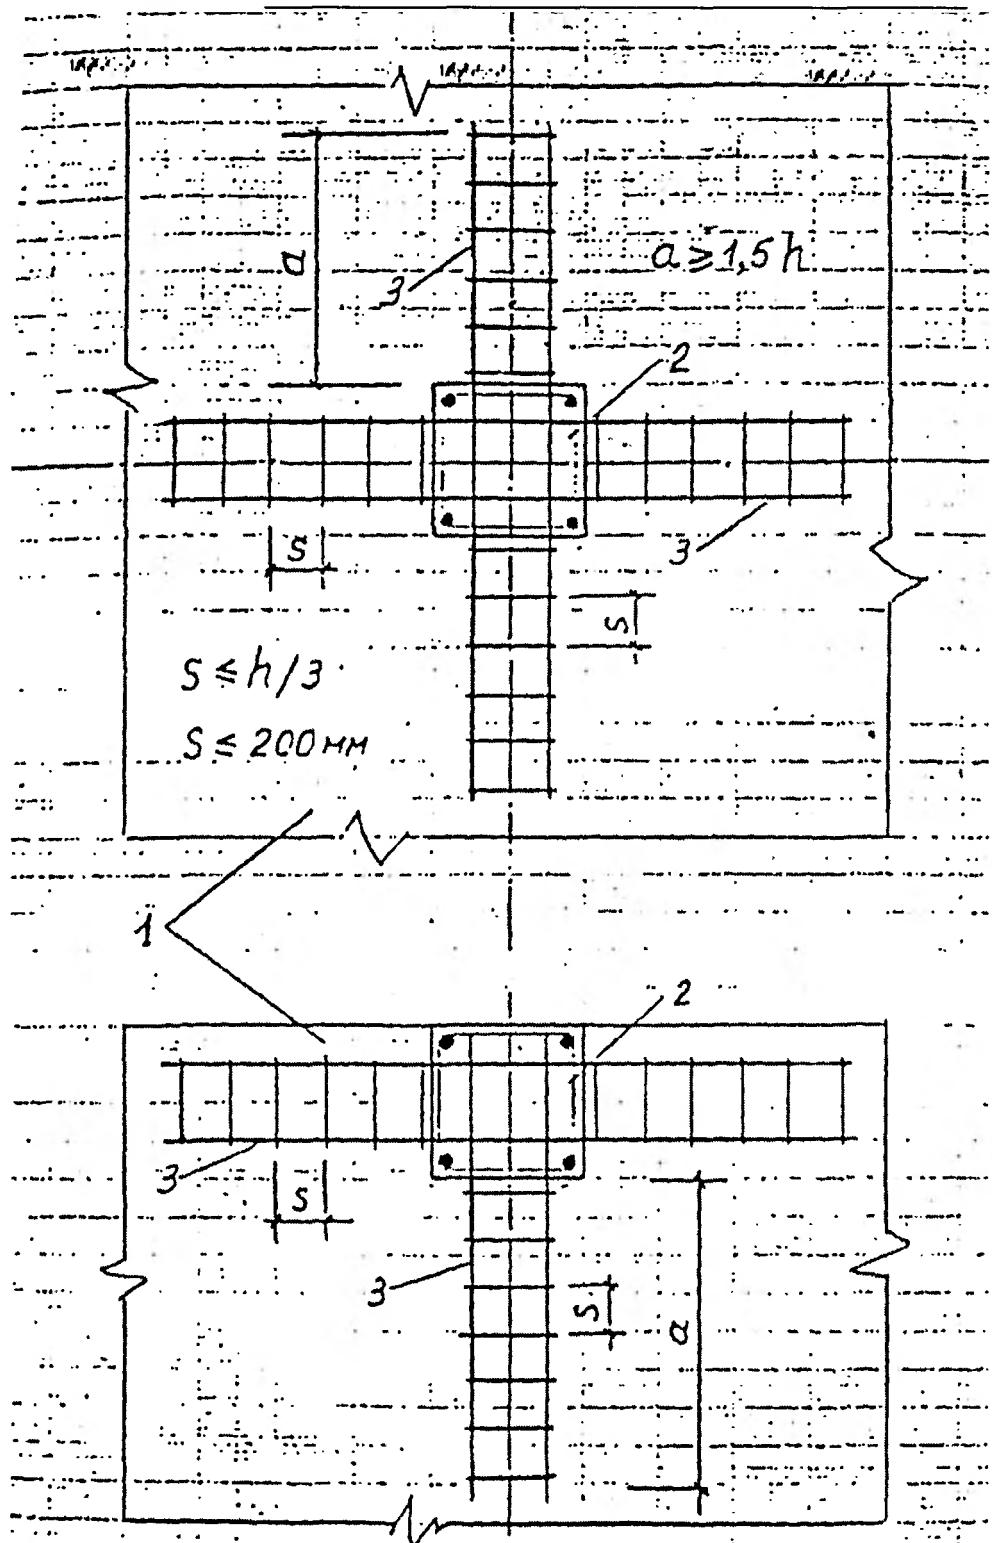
Поперечная арматура в зоне узла сопряжения плиты с колонной
